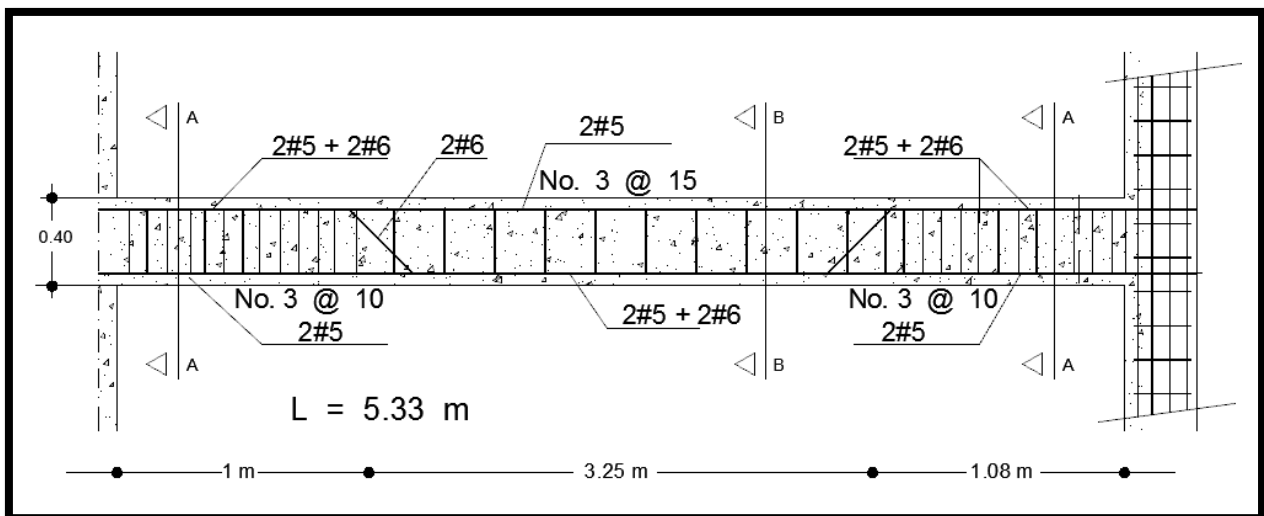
Viga E6 del pórtico A2-E2, Cuerpo 2.
